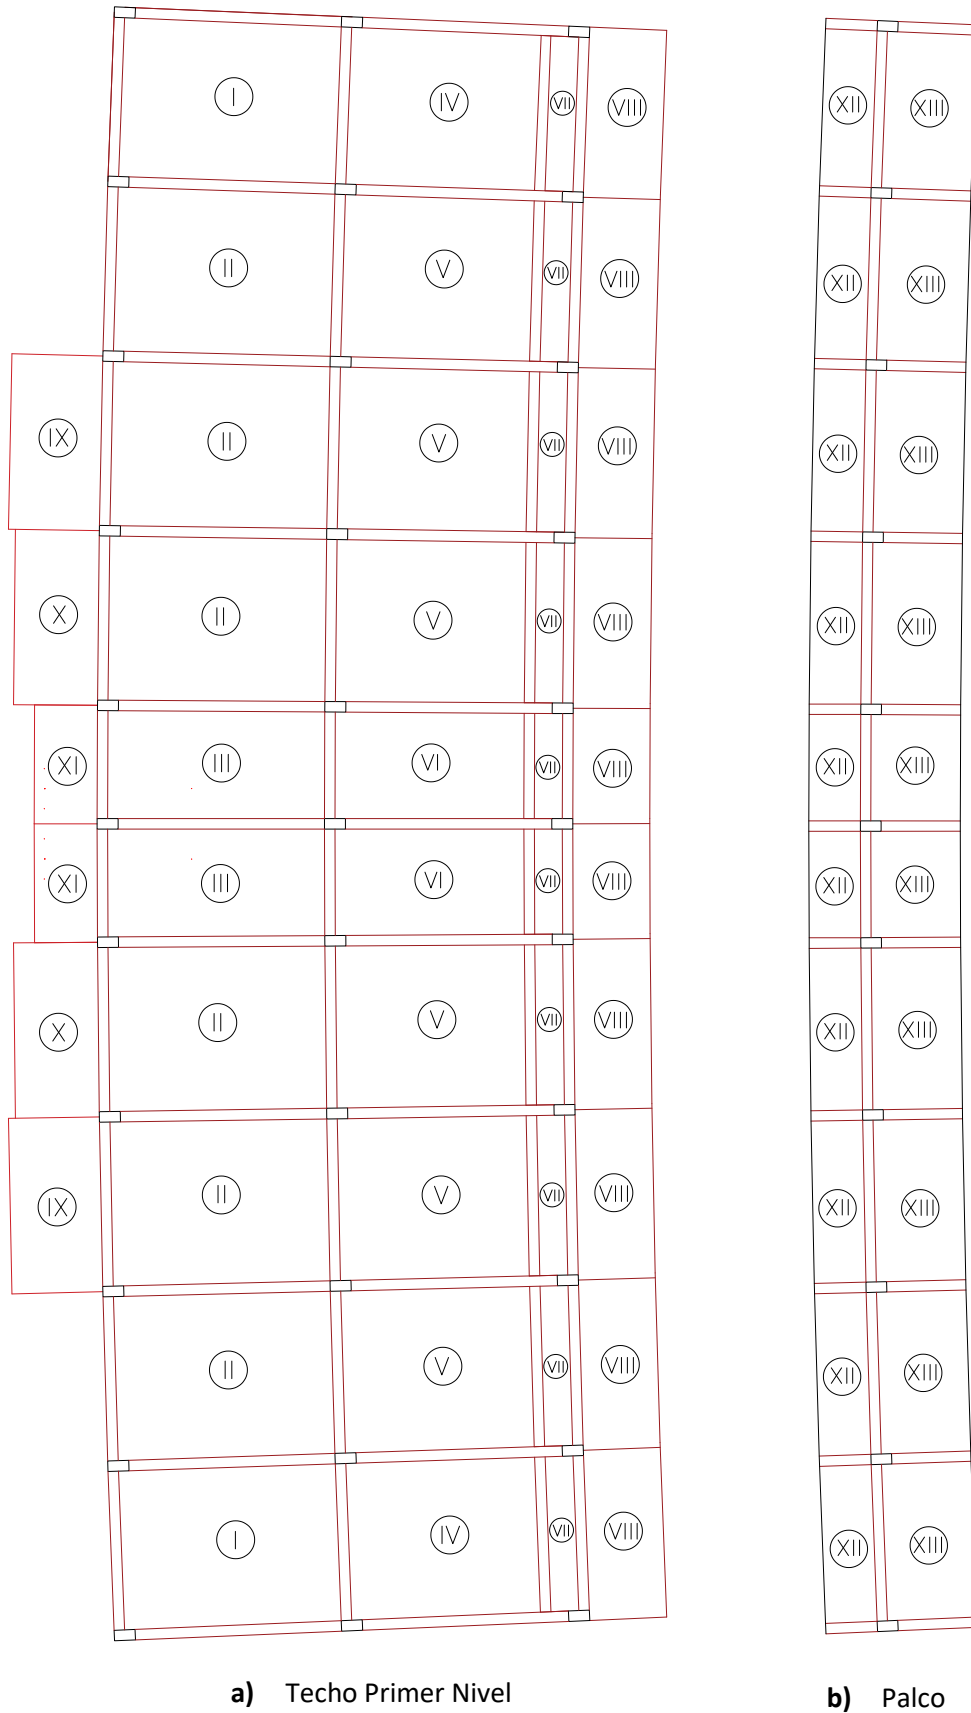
Distribución en Planta de Paños de Losas – Bloque B
